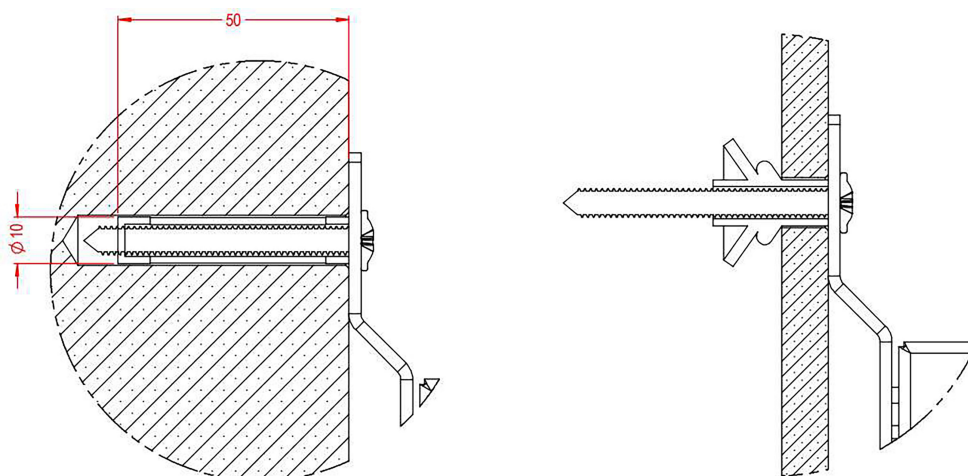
Detalles de fijación de los tableros en pared de concreto y ladrillo hueco
